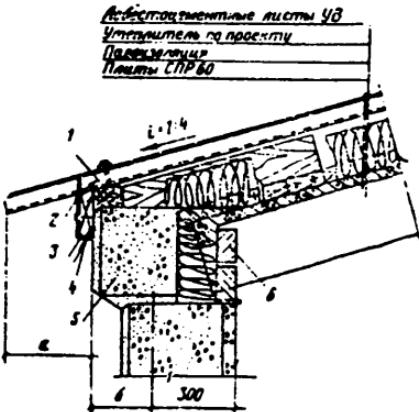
Конструкция карнизного узла при панельных стенах и асбестоцементной кровле:
